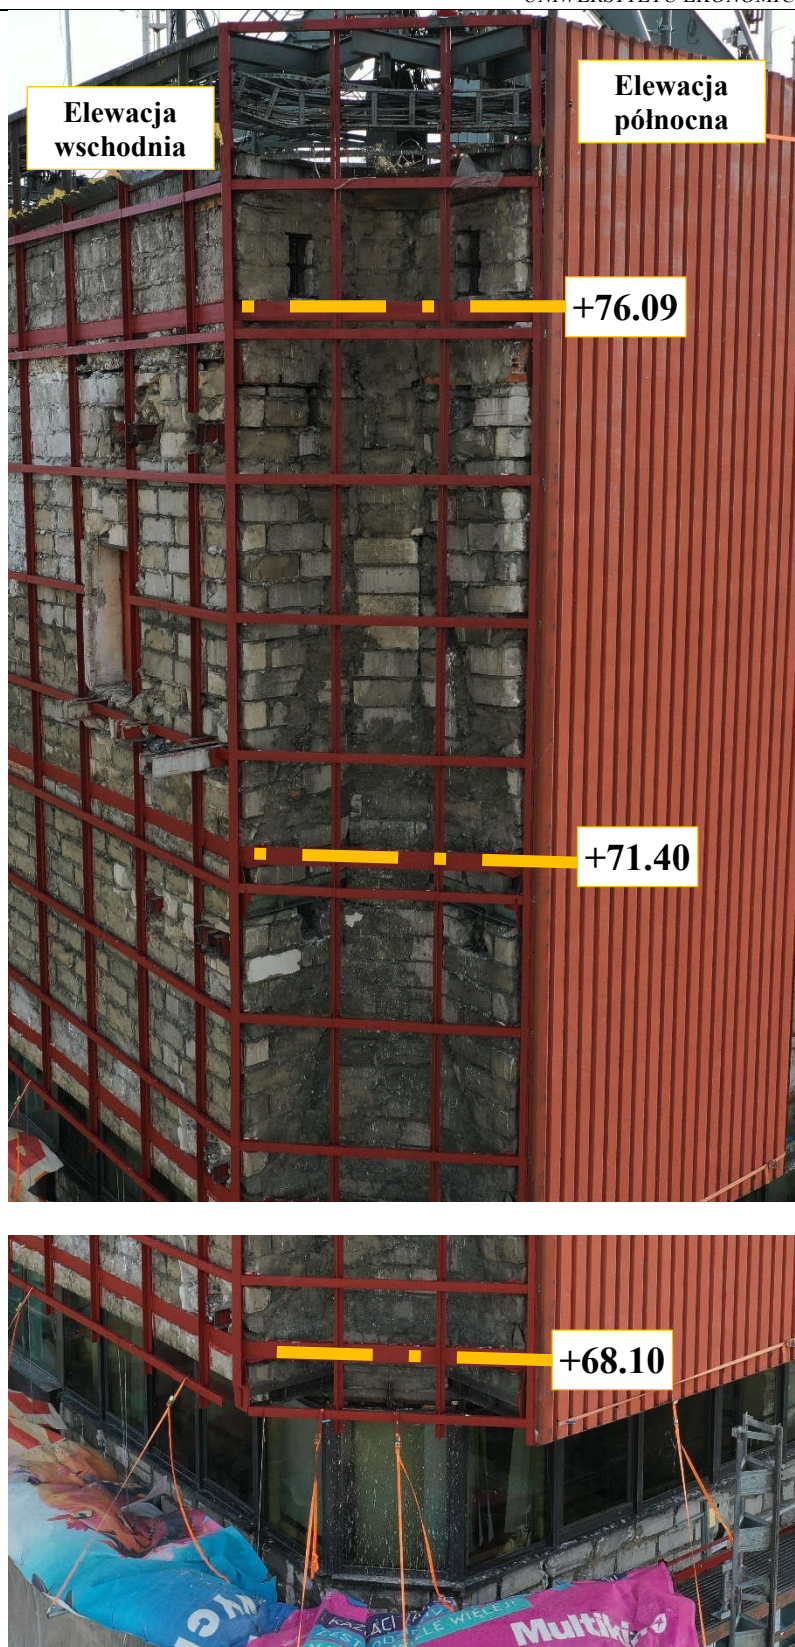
Widok ogólny elewacji wschodniej (oś 14) część 1/2
